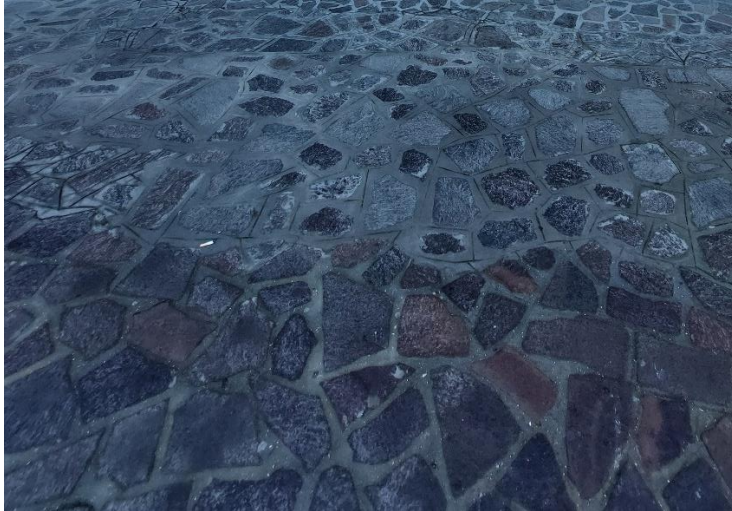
Pavimentazione in porfido a spacco presente attualmente sull'ultimo tratto delle Fondamente Nove, e che prevede il progetto ripresa dal tratto precedente a Ponte Donà
